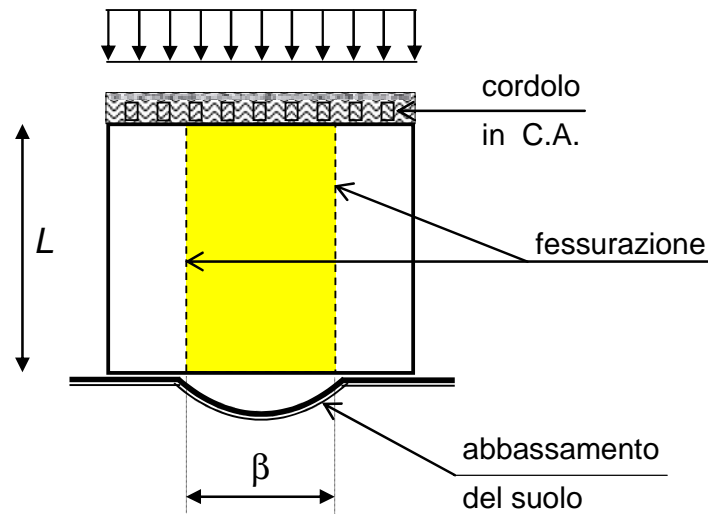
d. La base del muro subisce un abbassamento differenziale, con massimo al centro del paramento: abbassamento a conca causato dal terreno (p. es. dovuto alla modifica del contenuto d'acqua), oppure da una parete forata al piano inferiore (p. es. dovuto al cedimento della fascia di piano sottostante).
